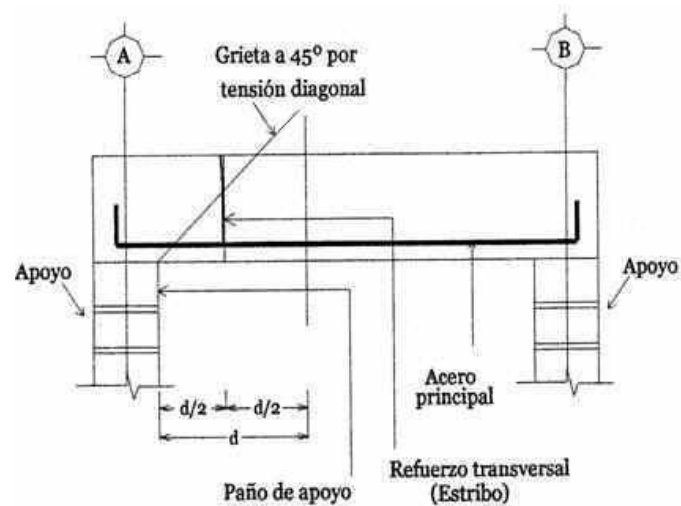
Elemento estructural. Se muestra el estribo como refuerzo transversal.
